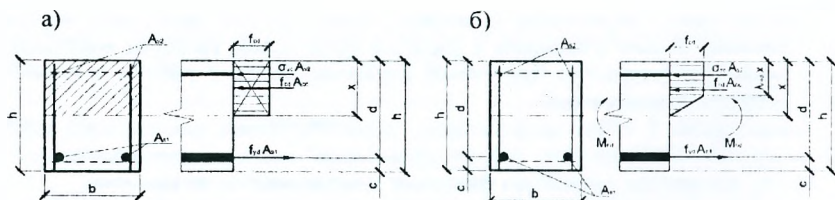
К расчету нормальных сечений железобетонных изгибаемых элементов:
